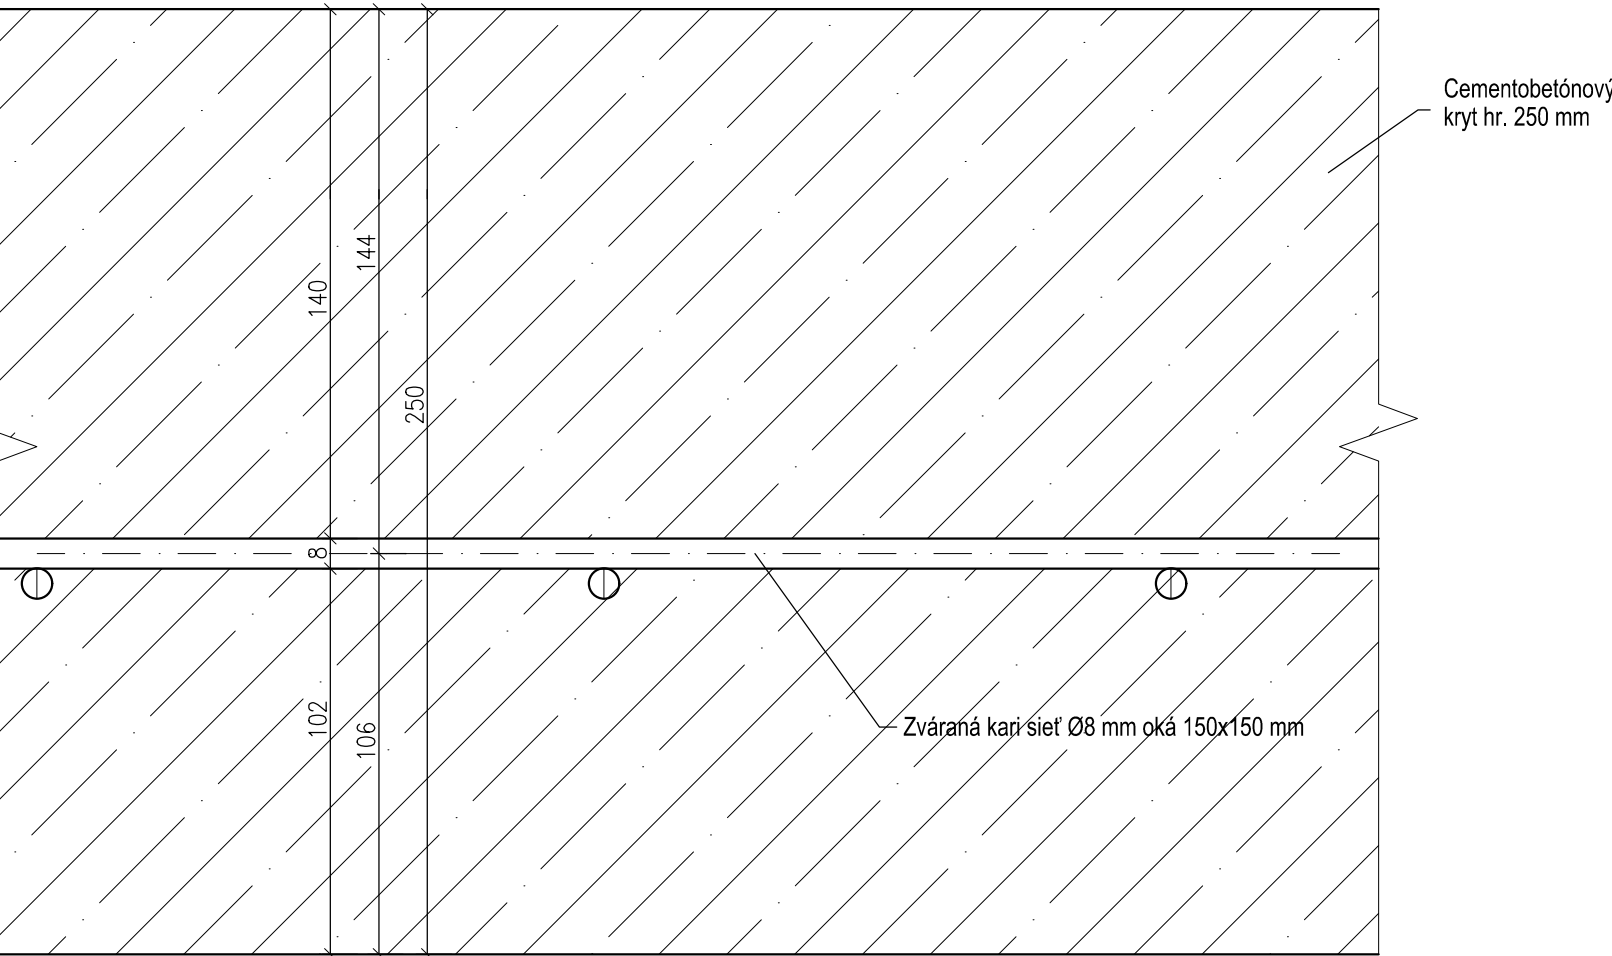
DETAIL PRIEČNEJ ŠKÁRY 1:2 (kótované v mm)
